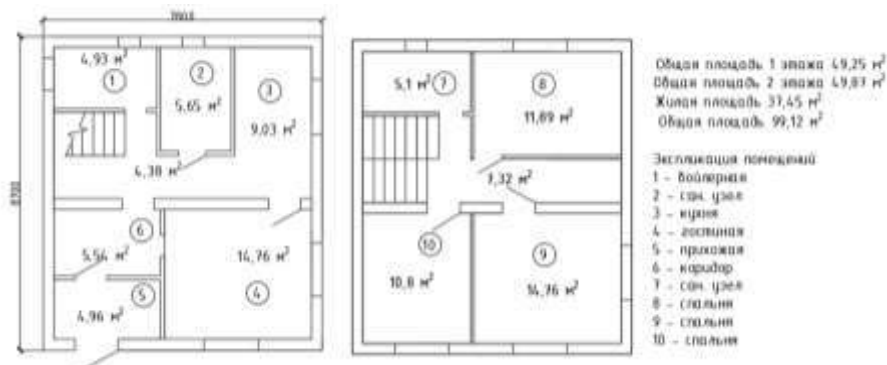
План двухэтажного дома со стенами из газобетонных блоков
